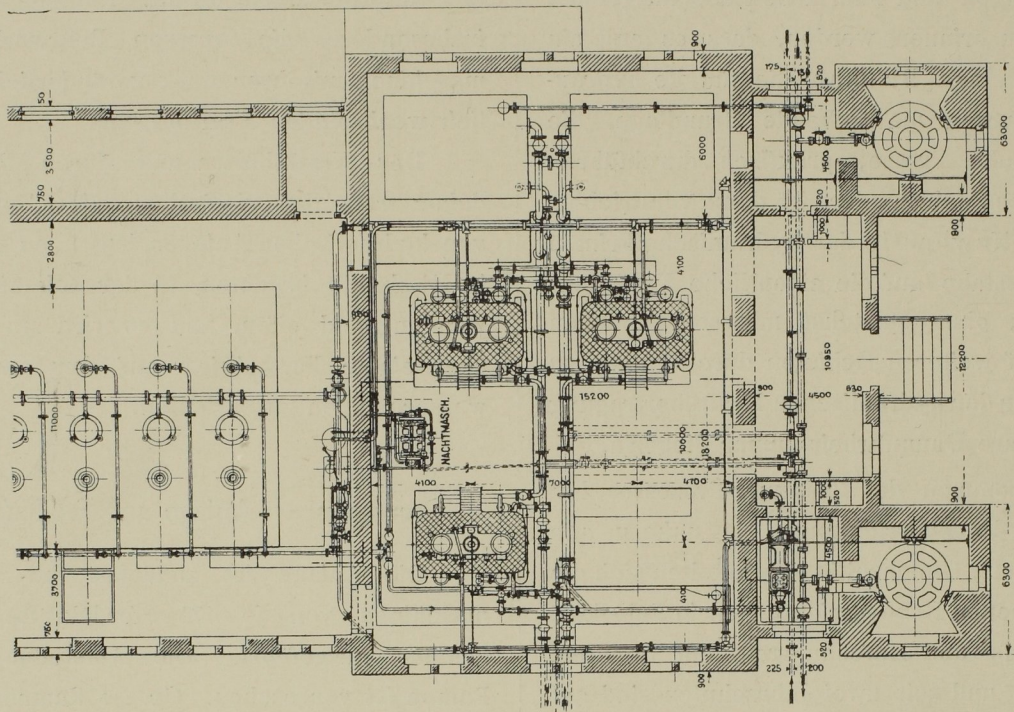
Grundriss des Maschinengebäudes. Massst. 1 : 300.
